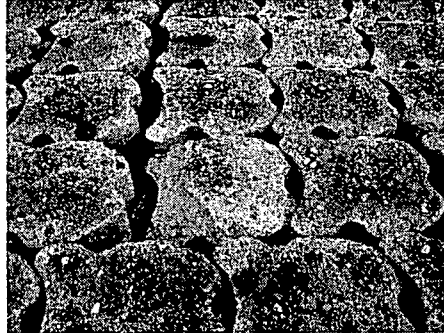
afgebroken toplaag betonzuil (dijkpaal 226)
